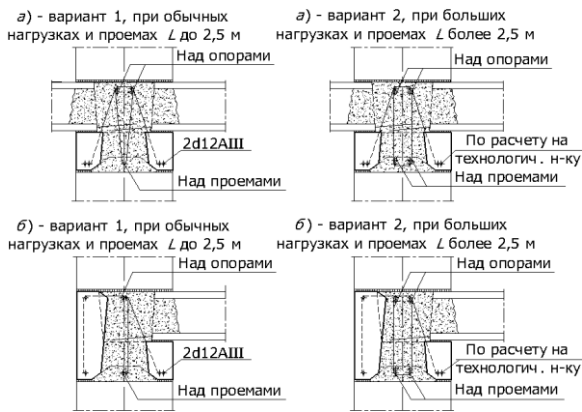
Конструирование сборно-монолитных поясов с учетом испытаний.
